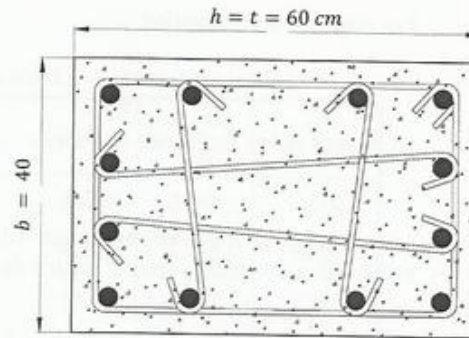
Colocación adecuada del acero transversal en columnas (los ganchos se doblan hacia el centro de la columna)
